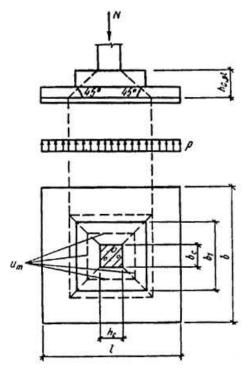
Схема образования пирамиды продавливания в центрально-нагруженных квадратных железобетонных фундаментах.
